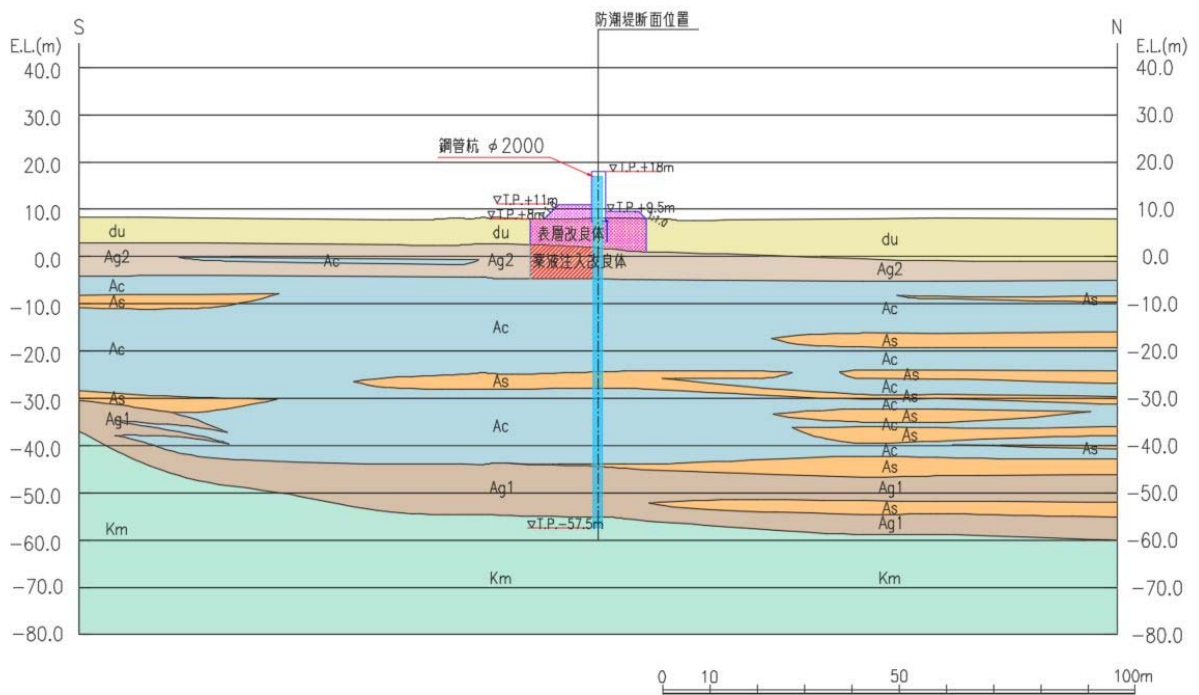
(4) 鋼管杭鉄筋コンクリート防潮壁 断面図 (断面④)
